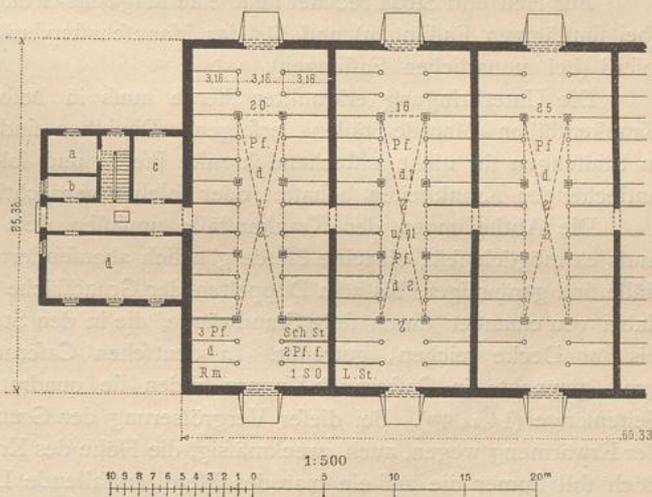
stellt den halben Grundriß eines österreichischen Escadron-Stallgebäudes mit Querreihenstellung⁴⁹⁶⁾ dar. Die Erleuchtung wird hauptsächlich durch große Deckenlichter in den Dachflächen bewirkt.
